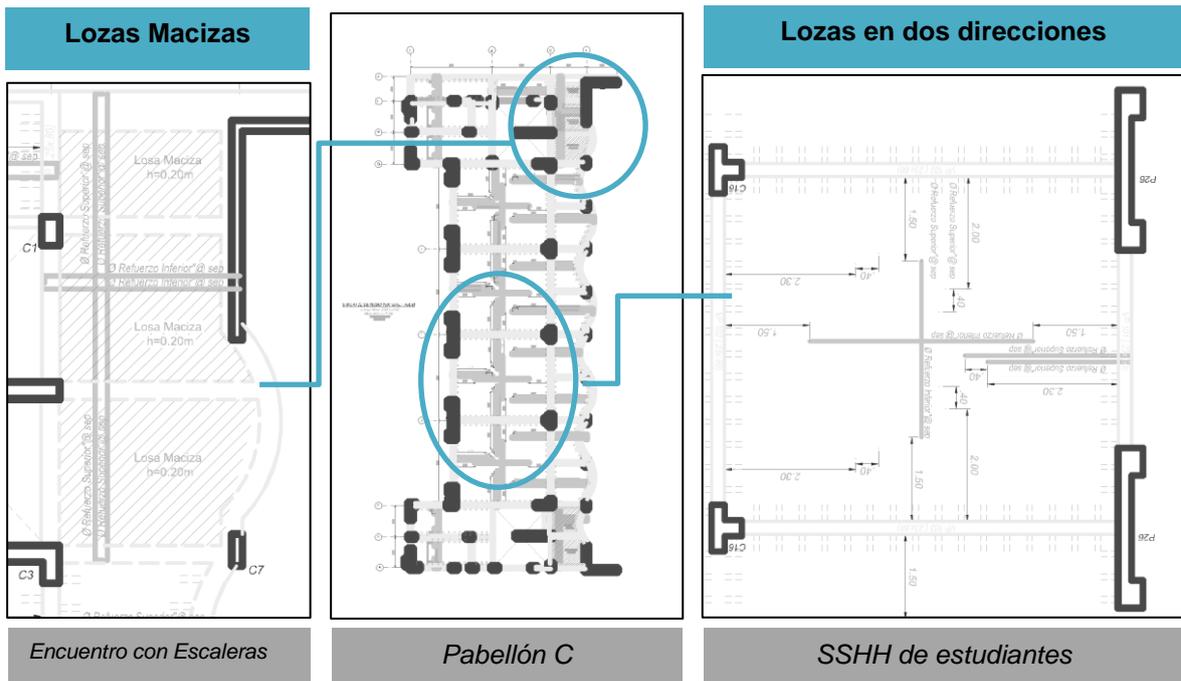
Tipos de Lozas aplicadas al Proyecto de la IIEE Antonio Raimondi
